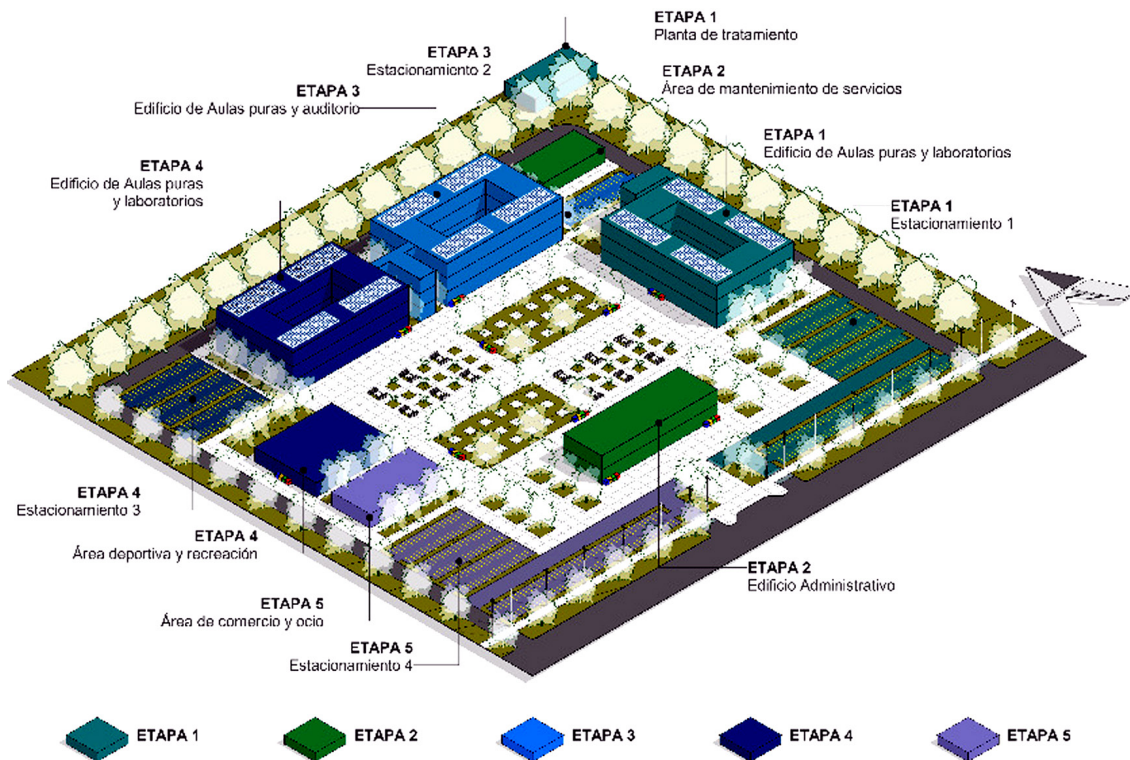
Ejemplo de un conjunto arquitectónico clasificado por etapas
